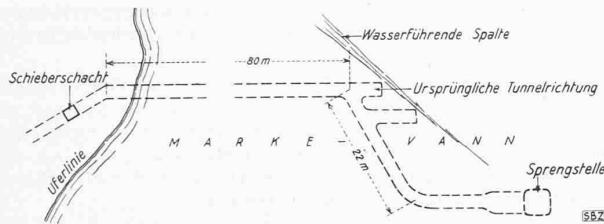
Grundriss vom Anstich-Stollen am Marke-Vann
